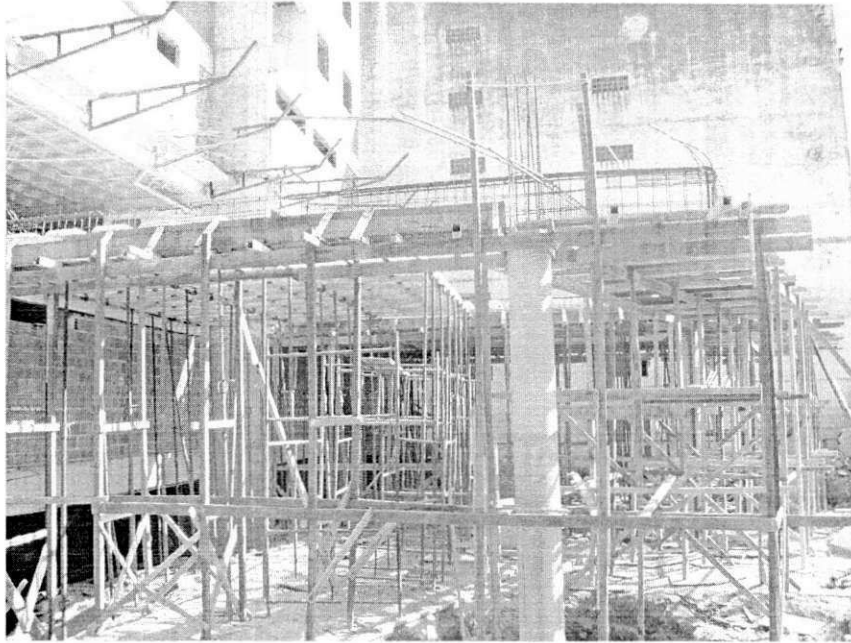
~~<sup>6</sup> Escoramento da laje a ser concretada. <sup>7</sup>
